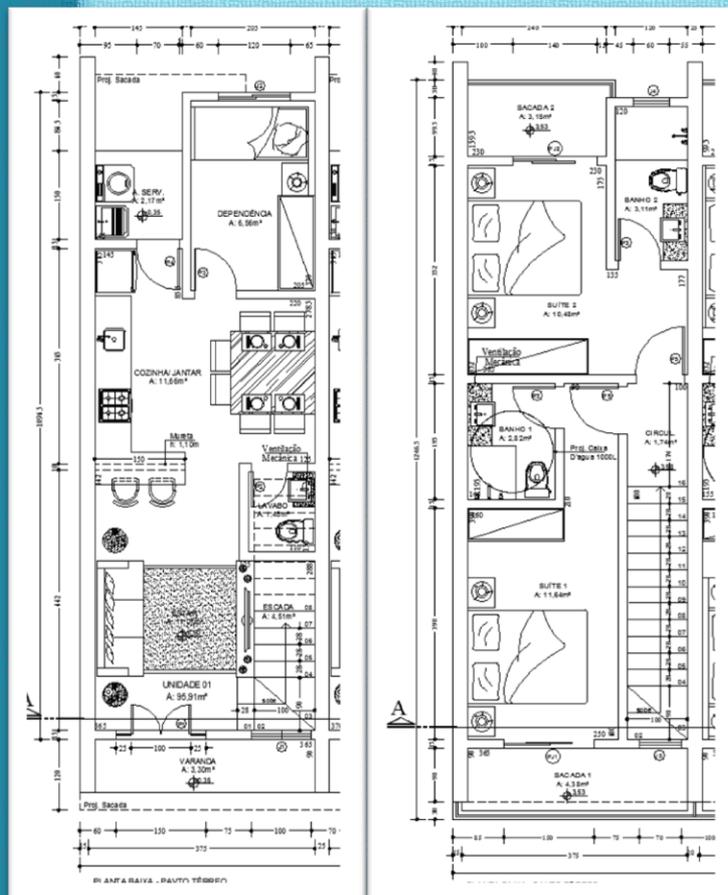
Planta Baixa, Casas Geminadas em Rainha/RS – 2012
